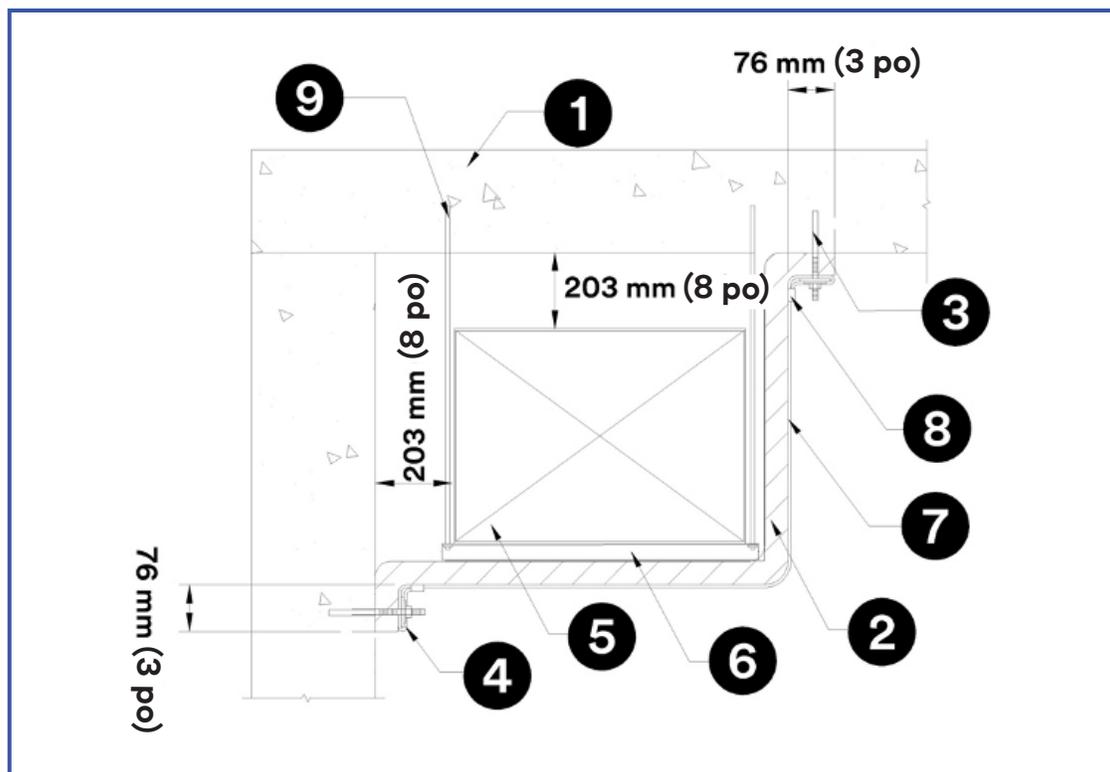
Installation suggérée sur un conduit de ventilation à deux côtés
